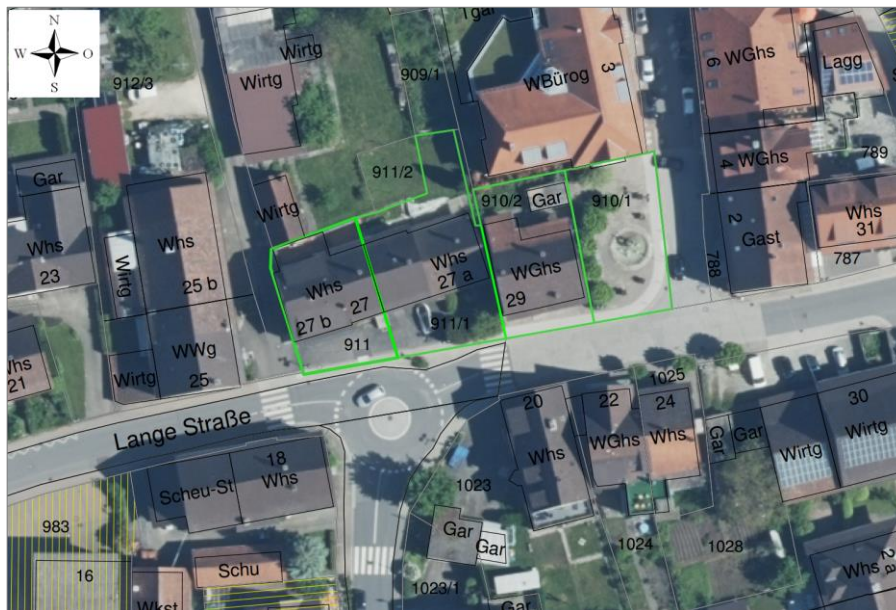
Lageplan Bestand, Lange Straße 27-29
